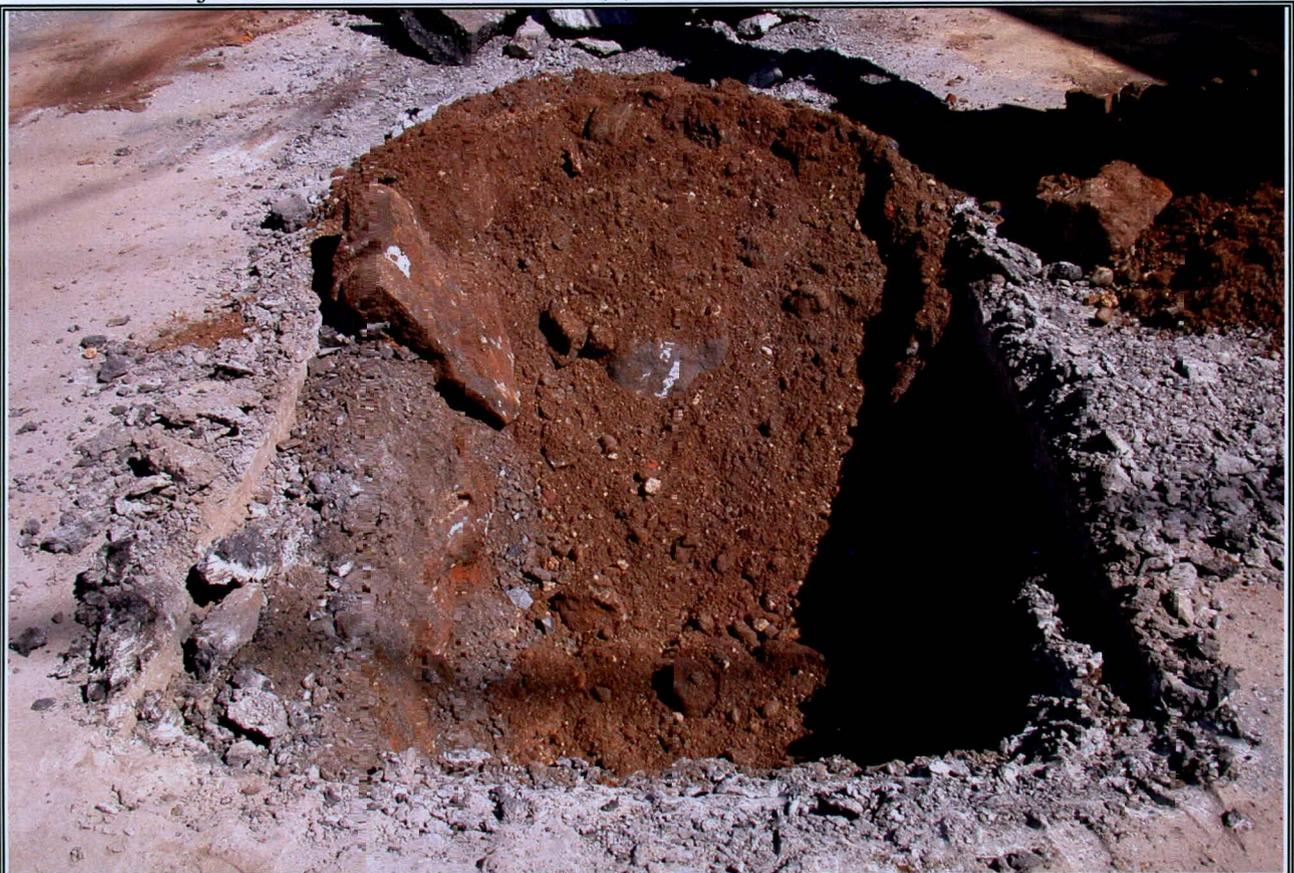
Projet n° 154-00-1342, tranchée 3 (O)
